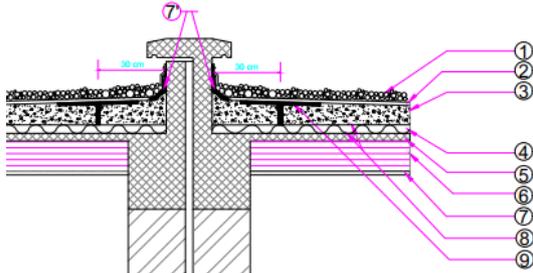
ابعاد Planchers terrasses inaccessibles
